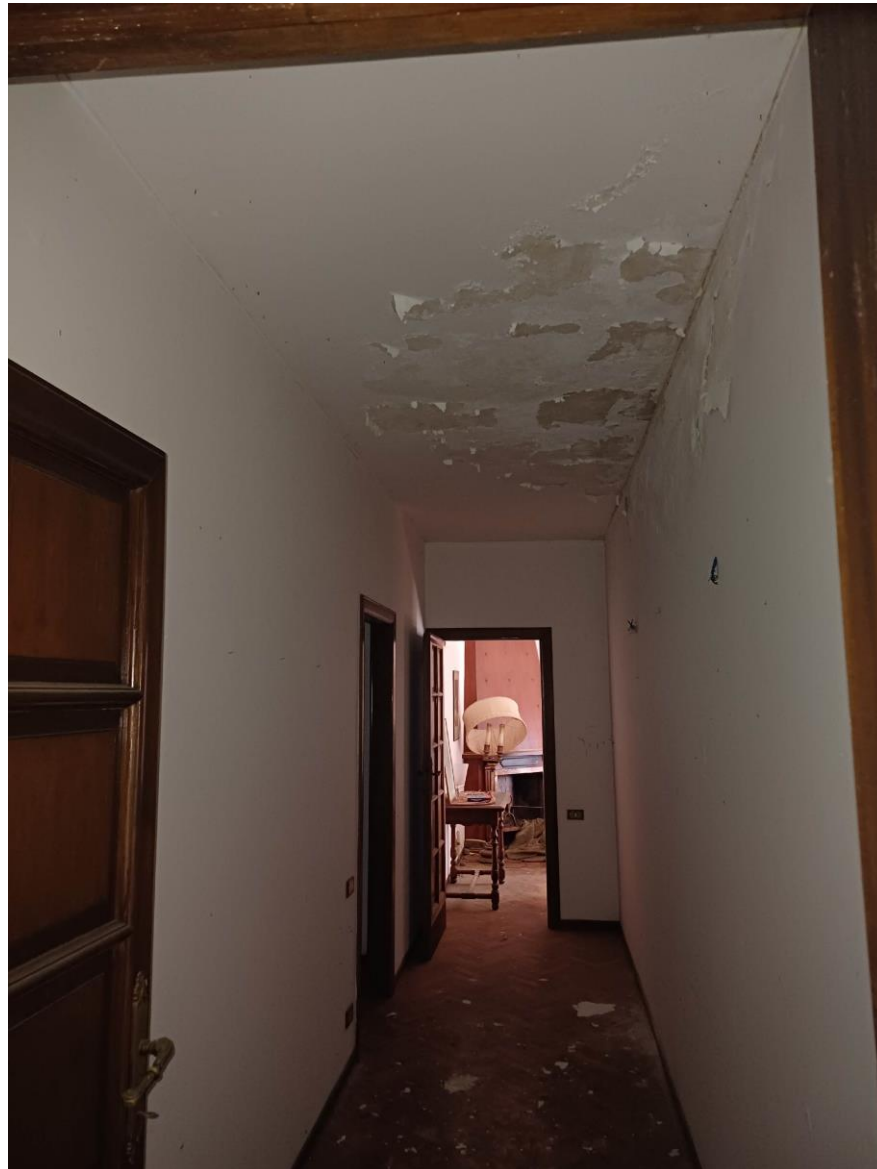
Corridoio 2 al piano primo Lotto n. 3
